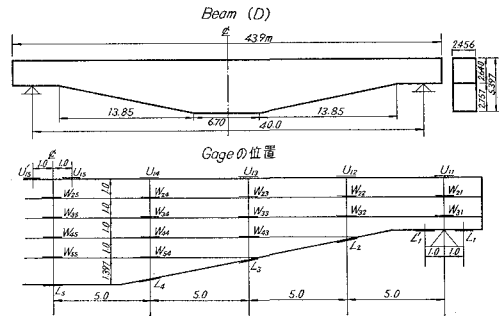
鋼矩形断面桁模型 Beam (D) の寸法及びゲージの位置
